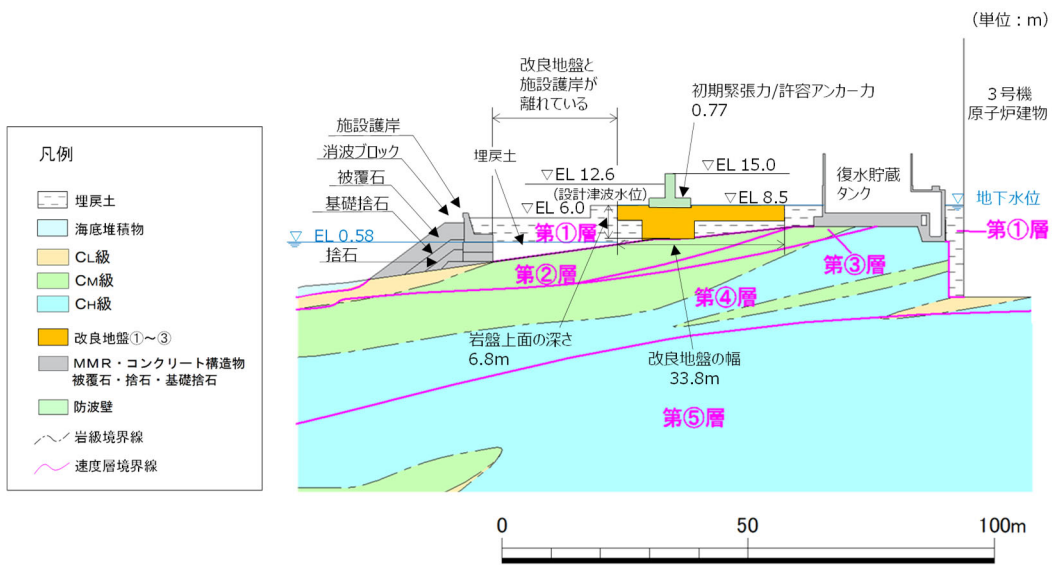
防波壁（逆 T 擁壁）の横断面図（③-③断面）
